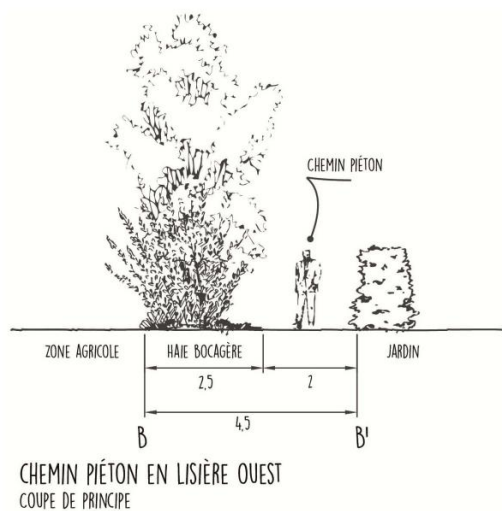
Coupe de la haie projetée en lisière Ouest du site
